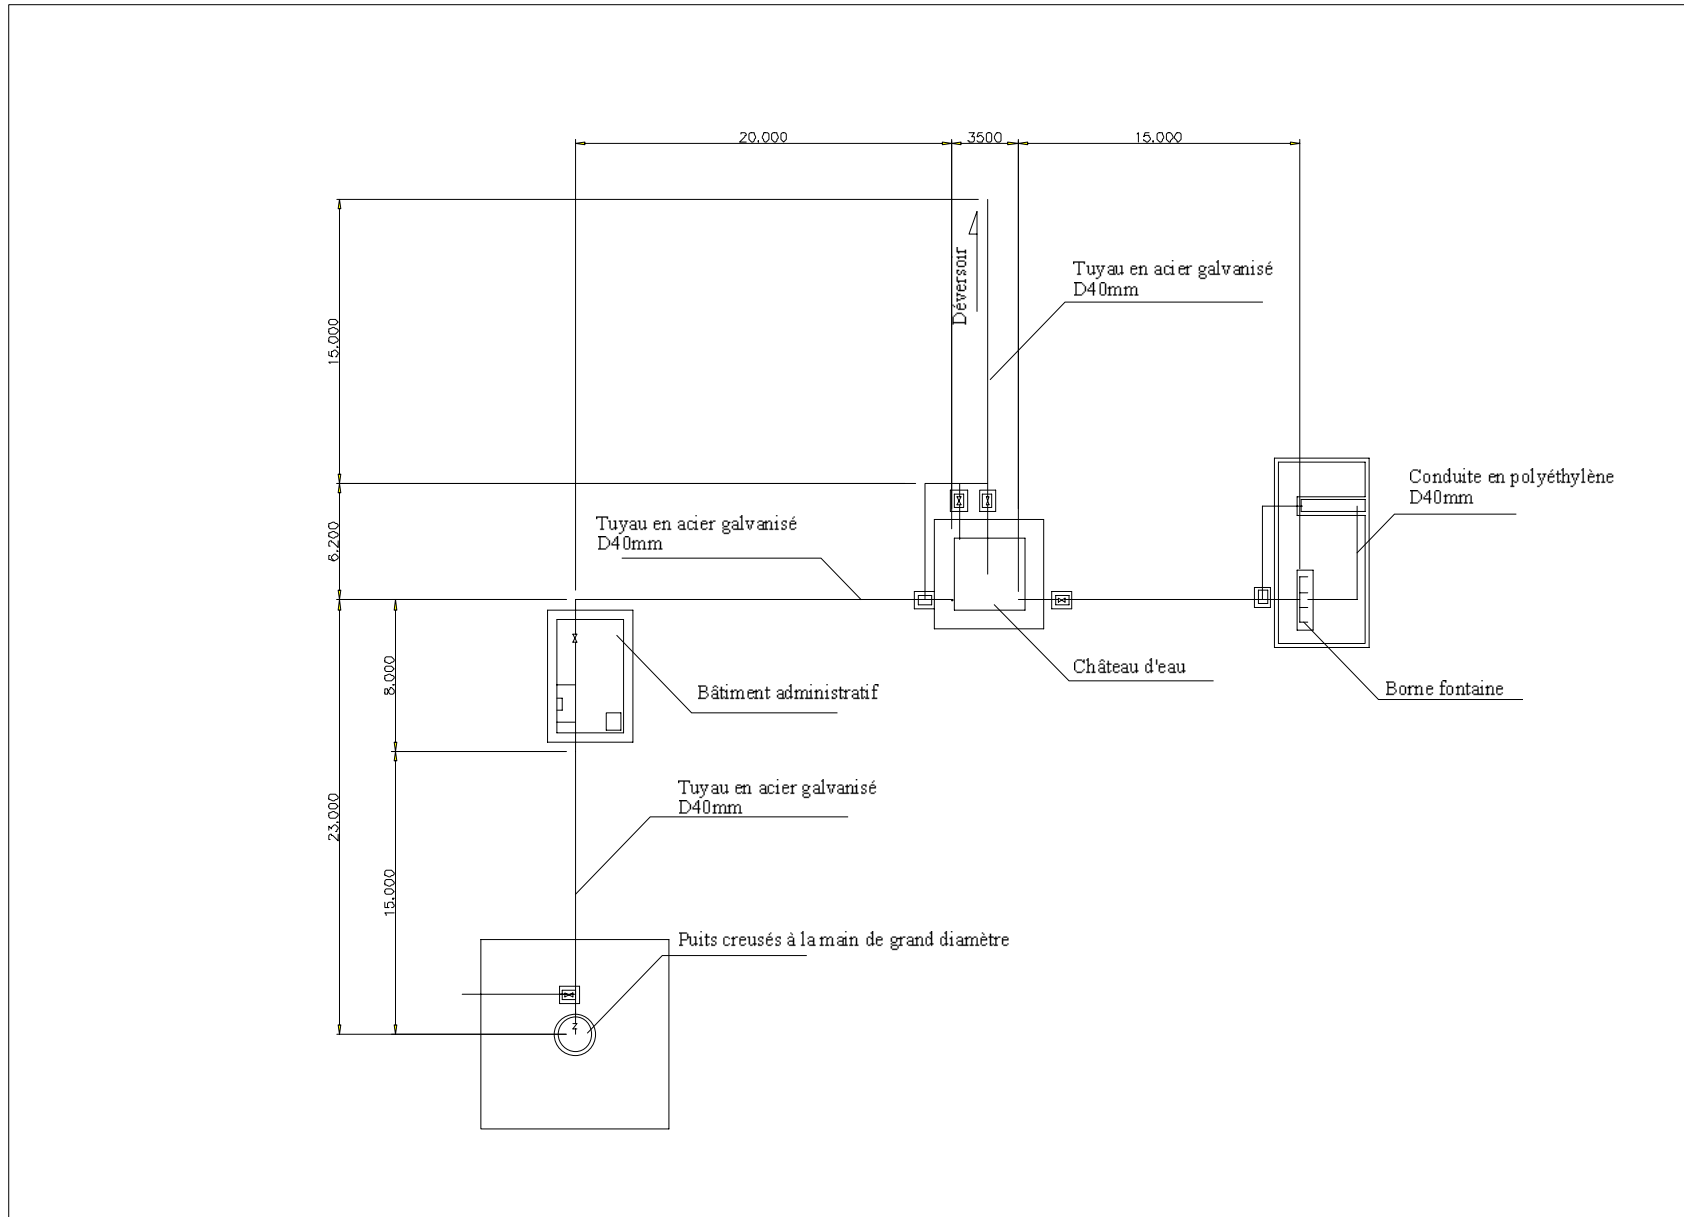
Plan d'implantation des installations d'alimentation en eau potable
